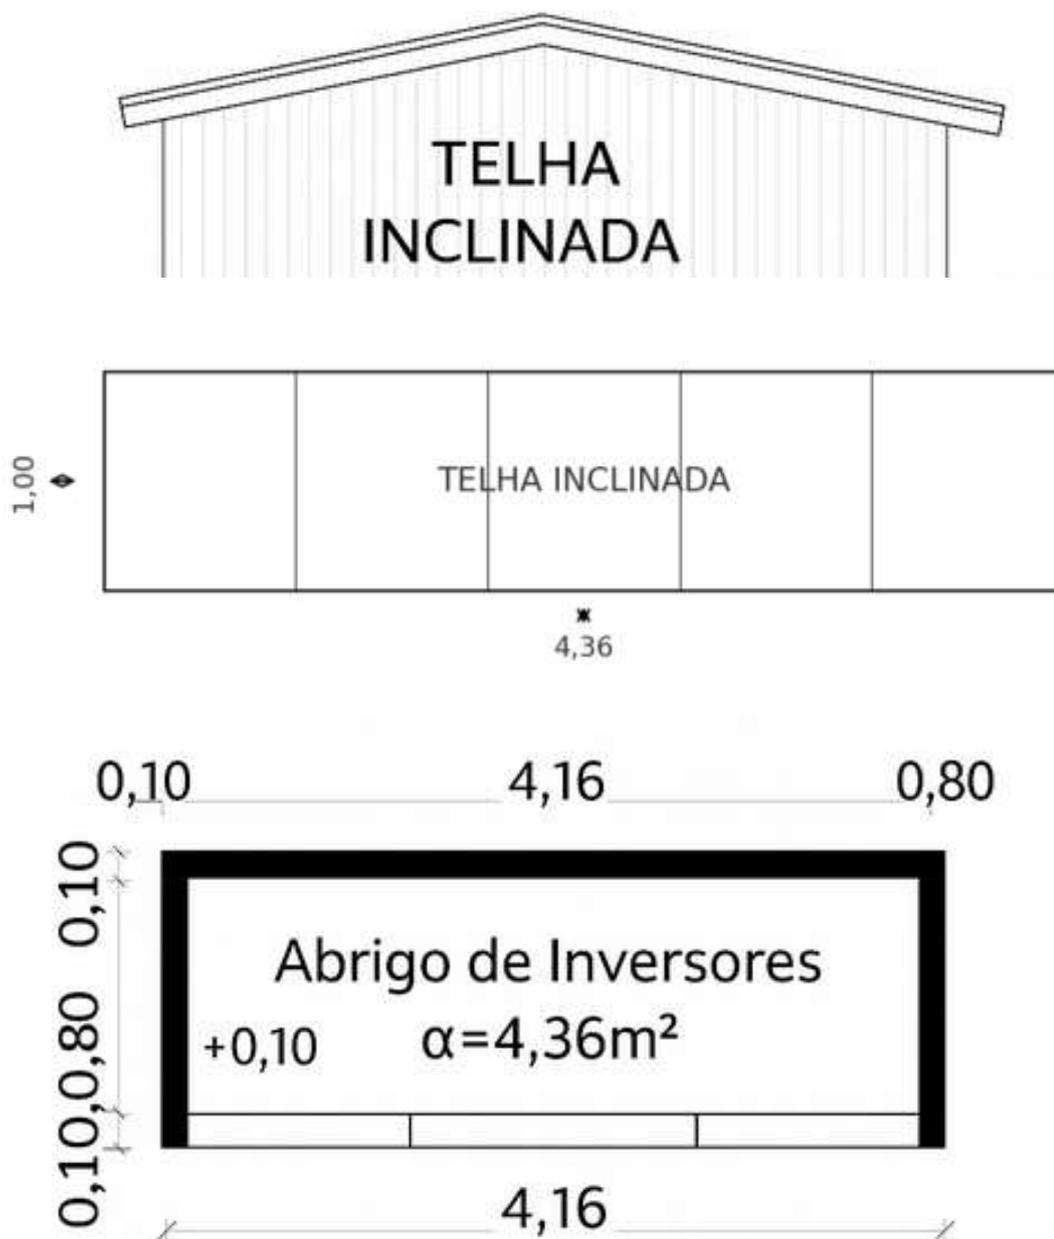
Planta baixa e detalhamentos dos abrigos de inversores.
